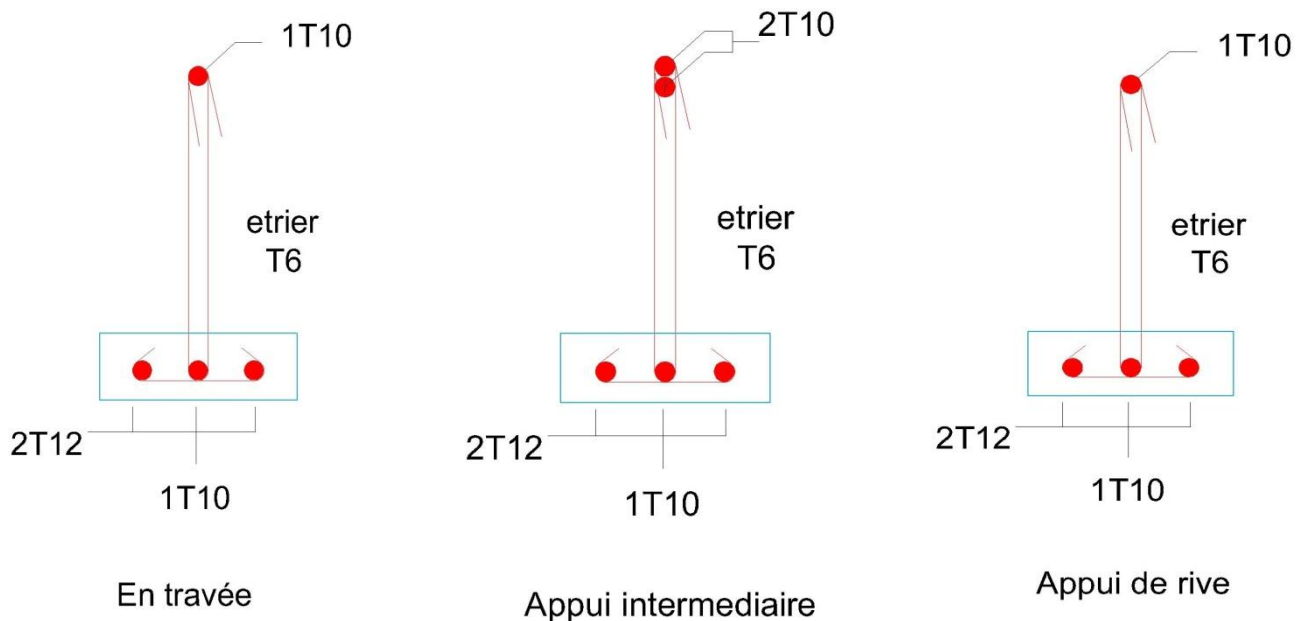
Schéma de ferrillage des poutrelles type1 de l'étage bureau
